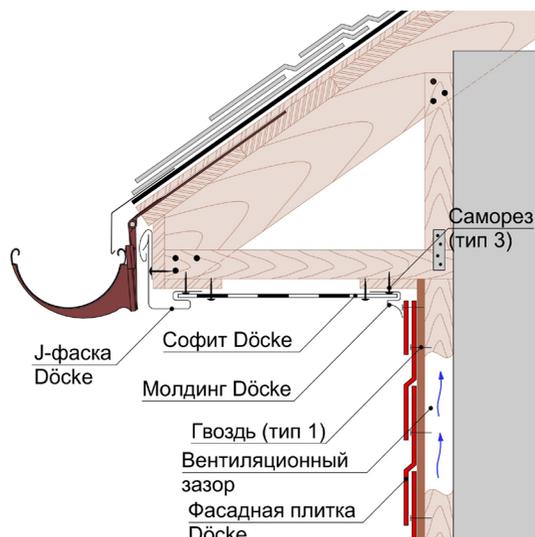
Примыкание фасадной плитки к карнизному свесу.
